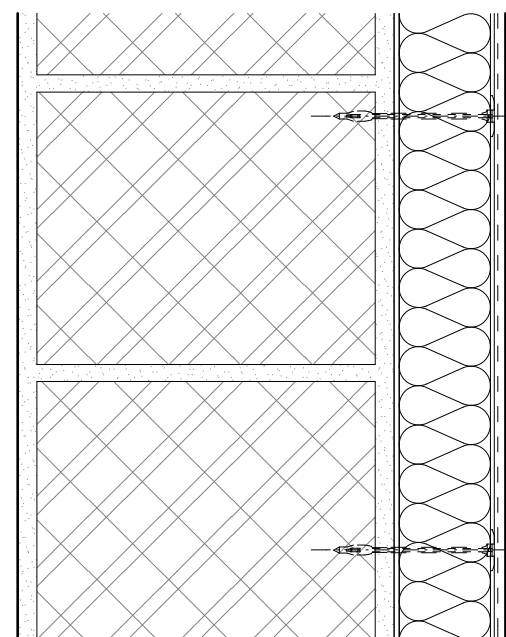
ZATEPLENÍ OBVODOVÉ STĚNY, M 1:10
